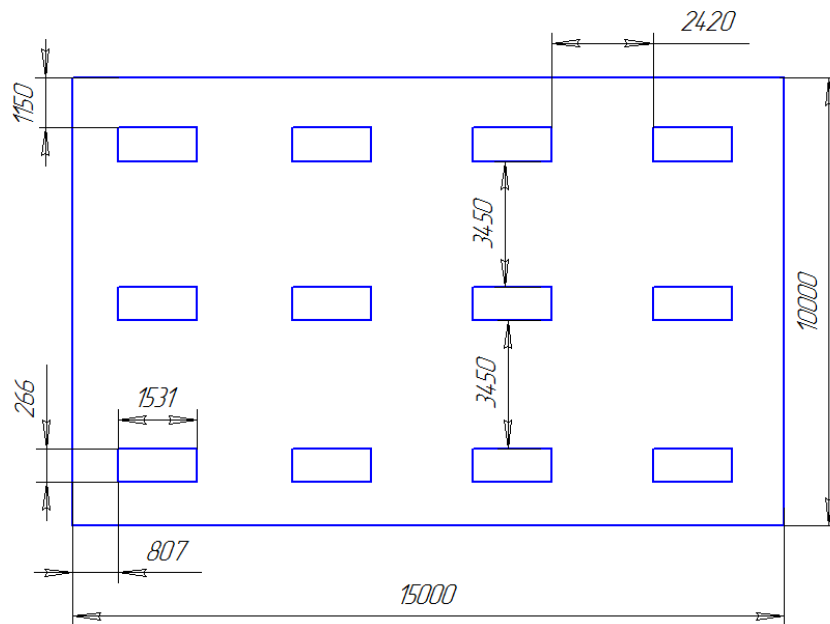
План помещения и размещения светильников с люминесцентными лампами
